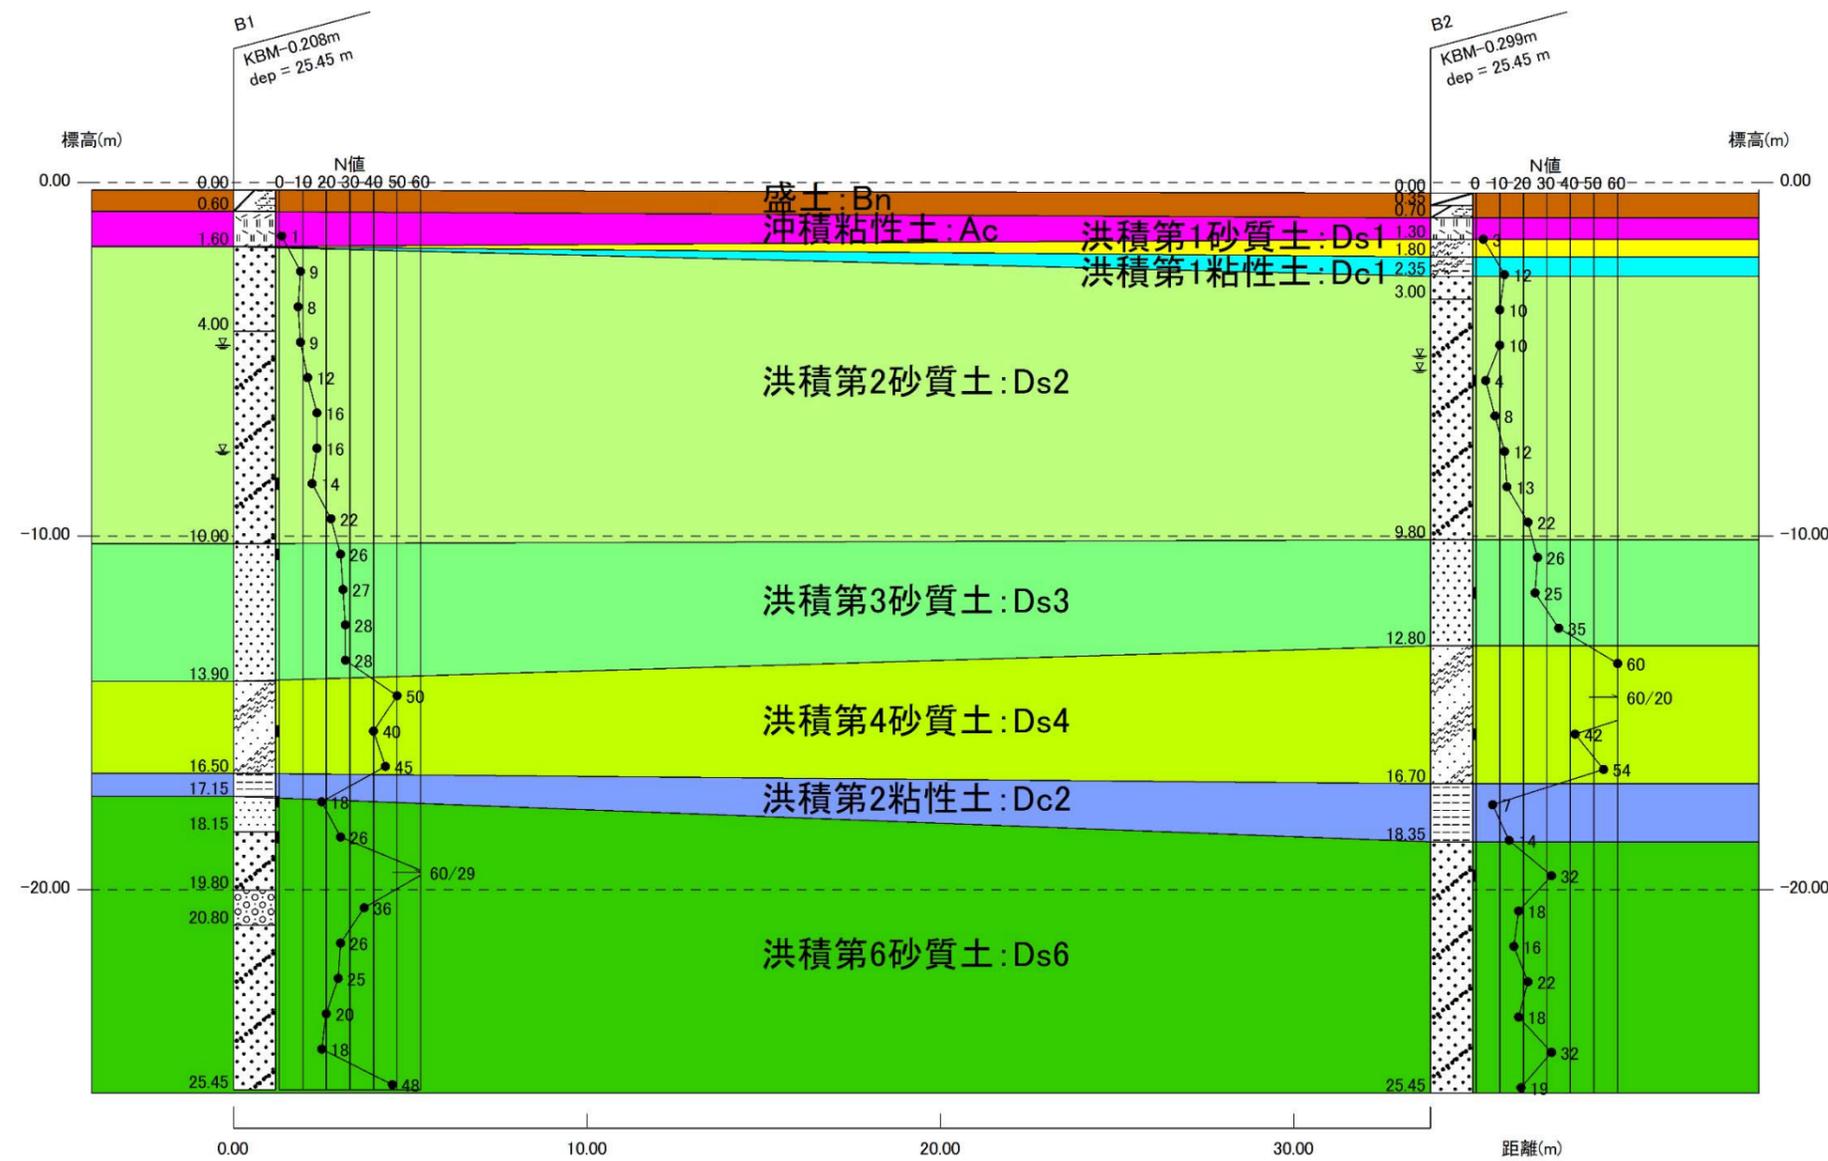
推定地層断面図 B1-B2 (S=1/200)
